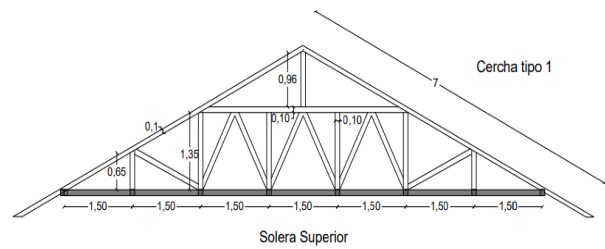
Propuesta de vigas secundarias en la cubierta
